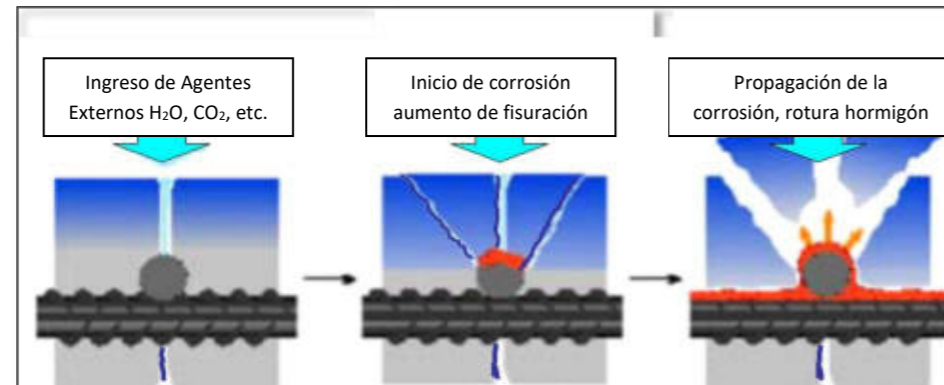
Proceso de deterioro del hormigón armado en presencia de fisuras
